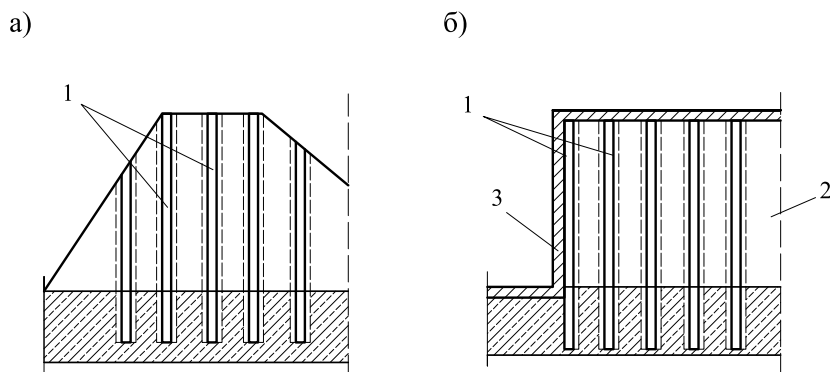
Схема підсилення основи вертикальними елементами: а – дамби; б – вертикального укосу; 1 – армувальні елементи; 2 – ґрунт основи; 3 – облицювання
